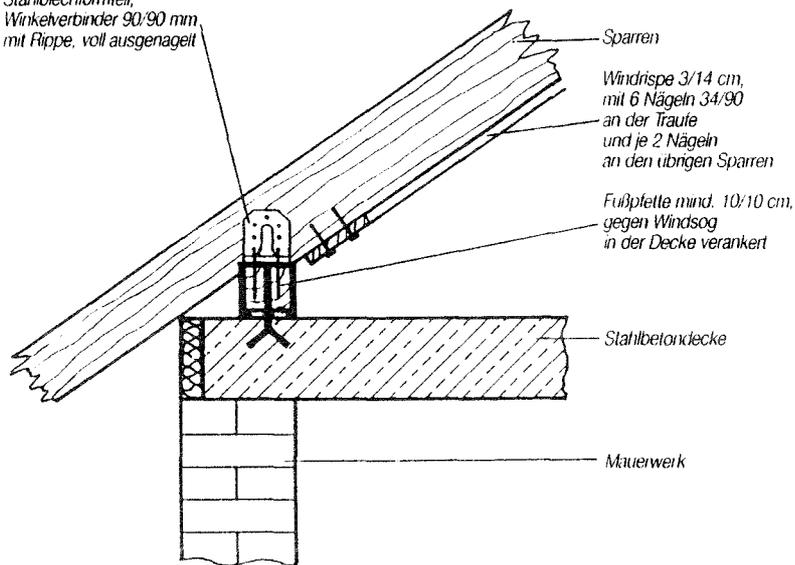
Traufpunkt-Details (z.T. nach [14])
